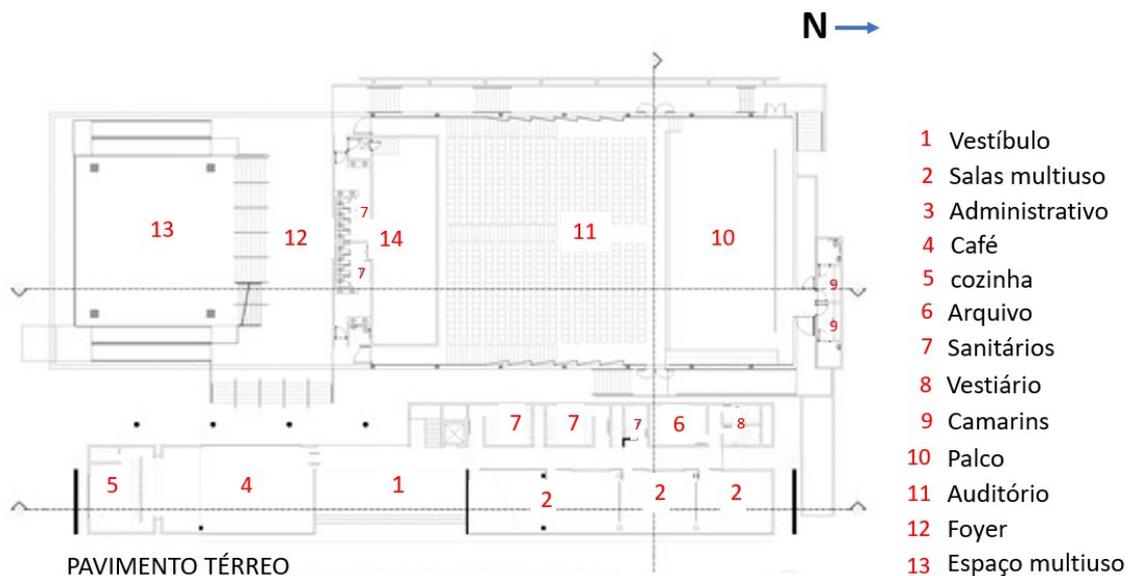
Planta baixa do pavimento térreo. Fonte: Adaptado do Archdaily, 2018.
